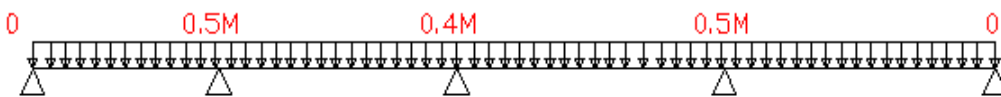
schéma statique d'une poutrelle a plusieurs travées
